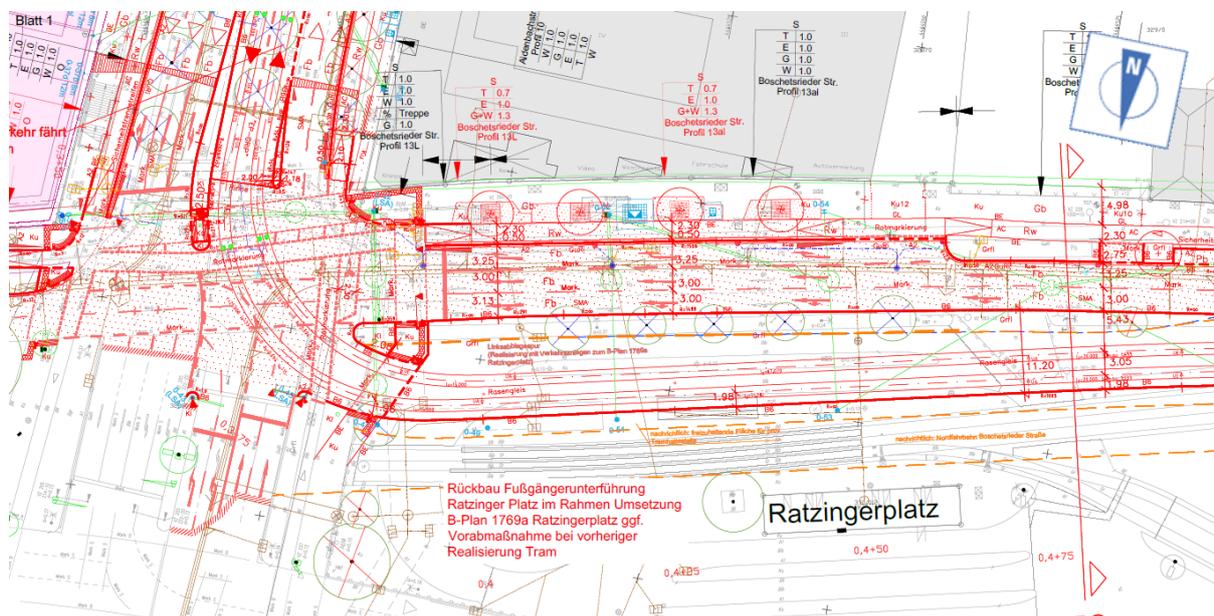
Radverkehrsführung westliche Zufahrt Ratzingerplatz gemäß Entwurfsplanung, Stand 02/2025 (Hinweis: Plan nicht genordet, siehe Nordpfeil im Planausschnitt oben rechts)
